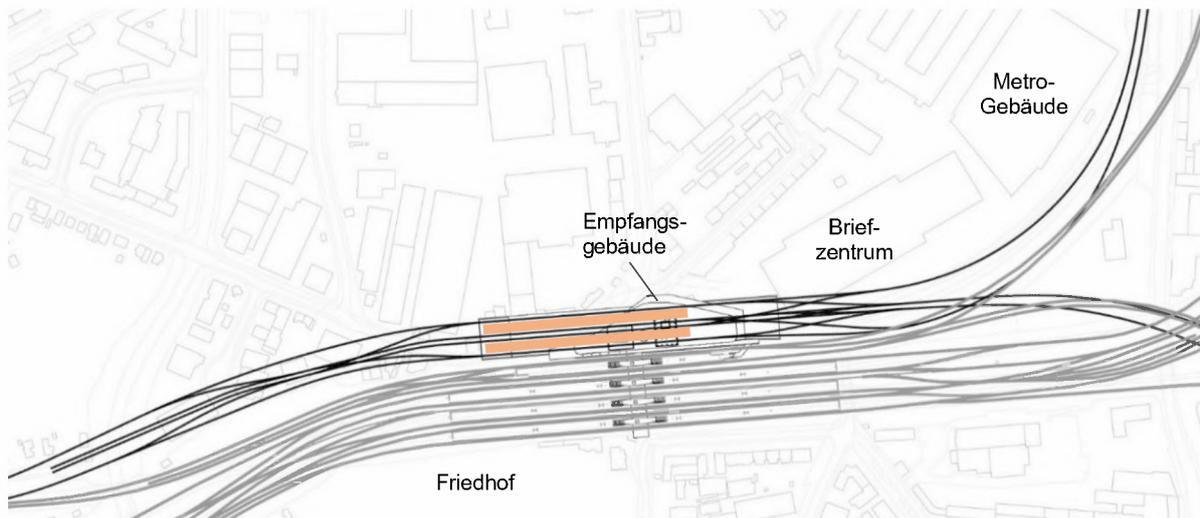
HP Altona Diebsteich IIIa - Lageplan
